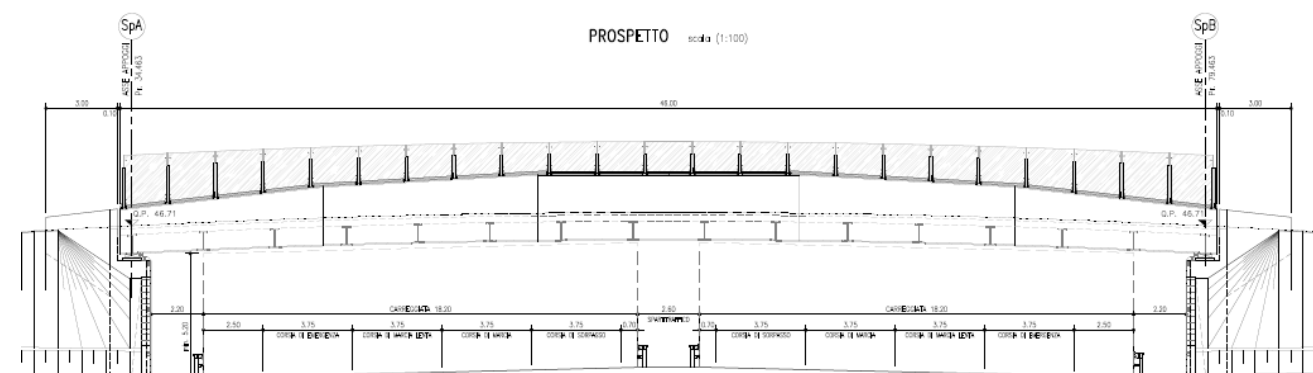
Sezione longitudinale cavalcavia a via inferiore
